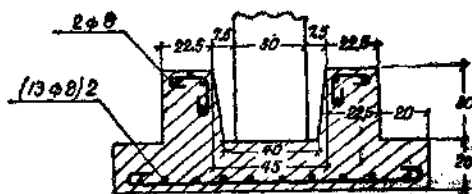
鋼筋混凝土杯槽(柱下面)示意图
